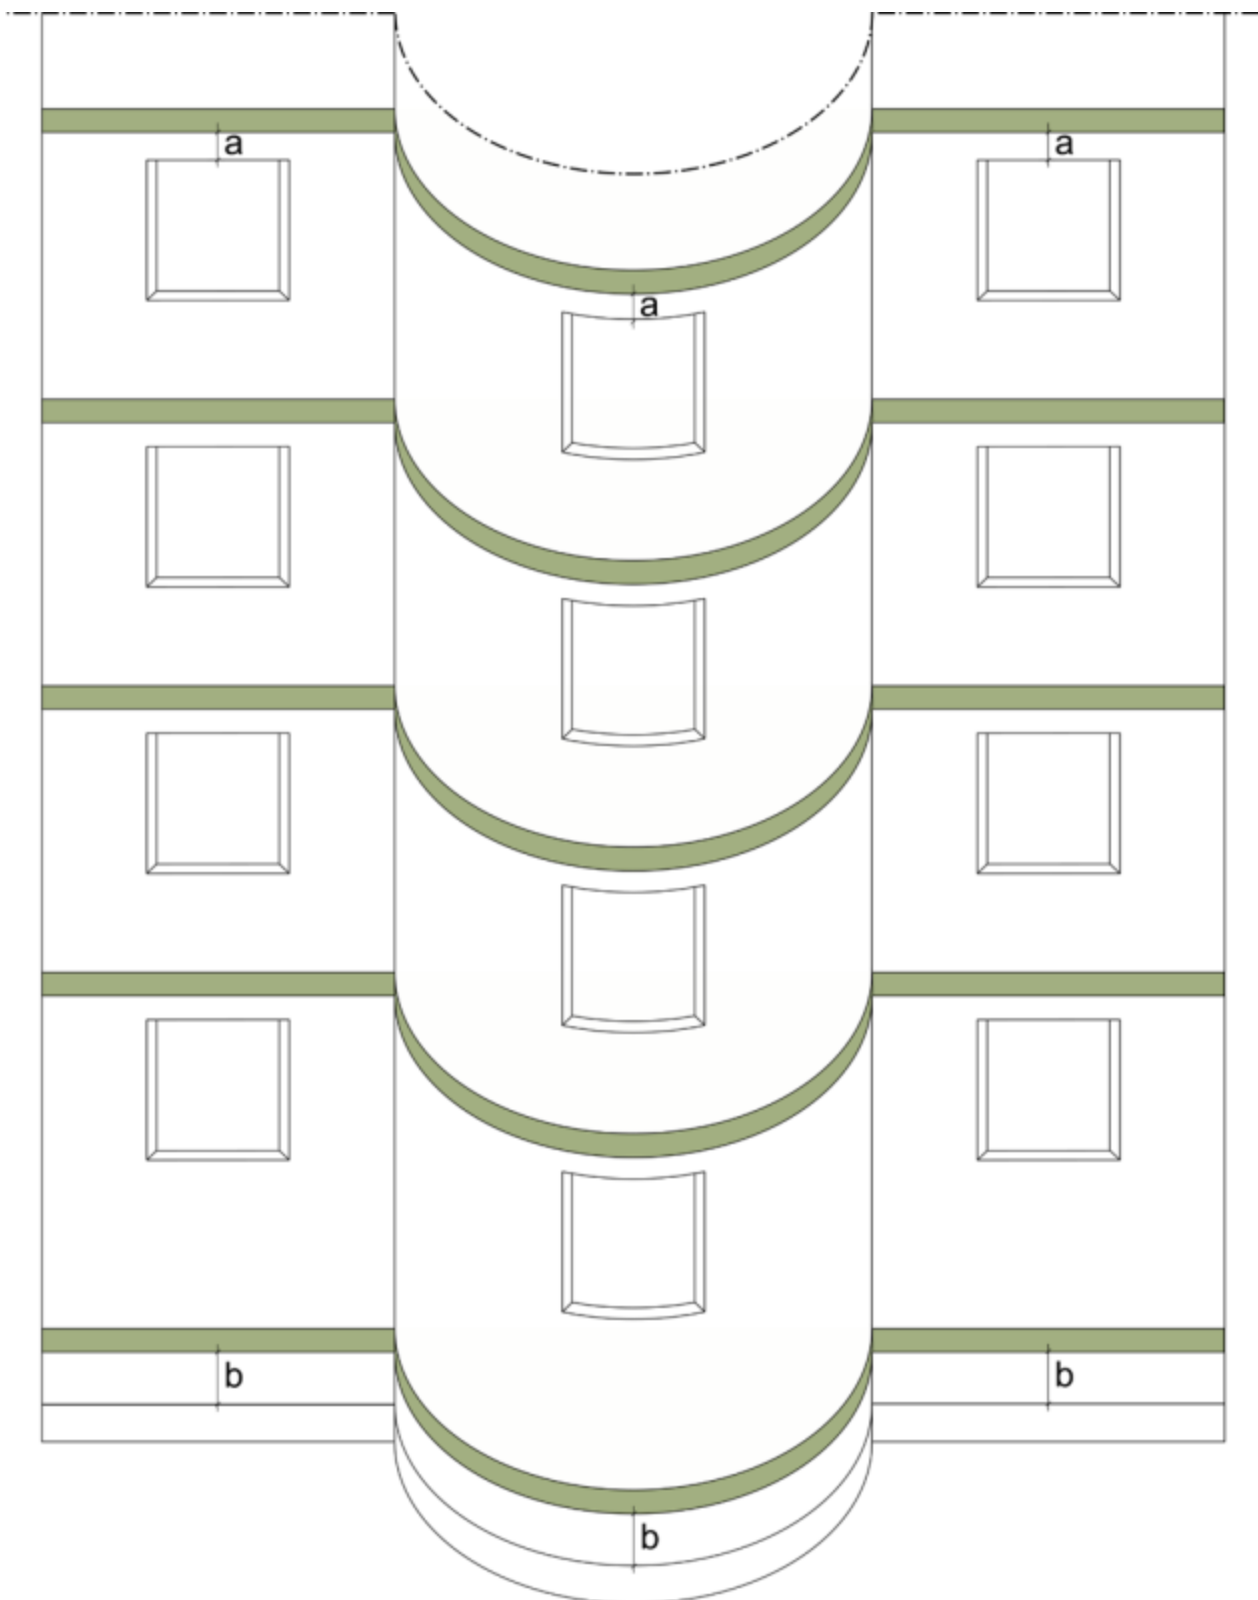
harpage des panneaux au raccordement entre façade courbe et façade plane
